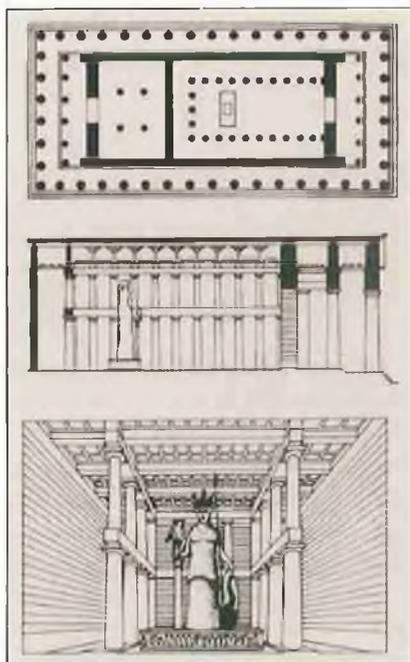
b) *Planta y alzado de el Partenón, Atenas.
